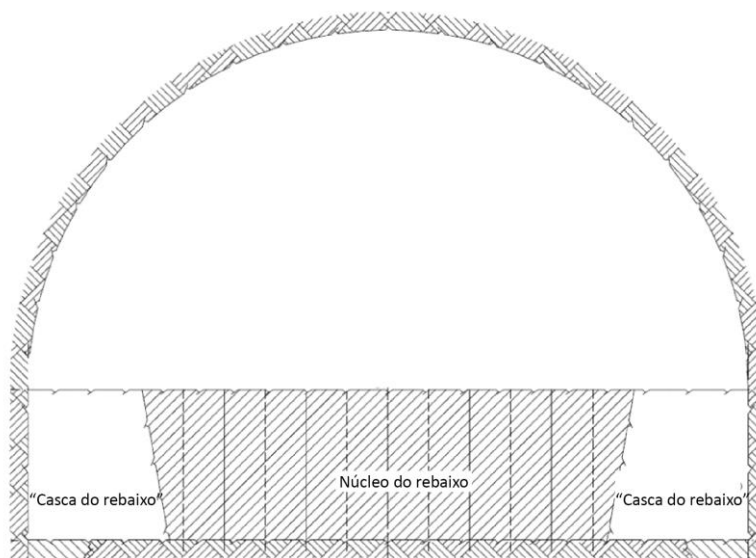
Escavação por calota e rebaixo com uso de furos verticais
